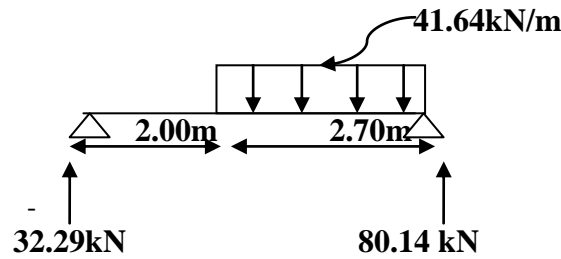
Schéma statique de la poutre palière de l'escalier
